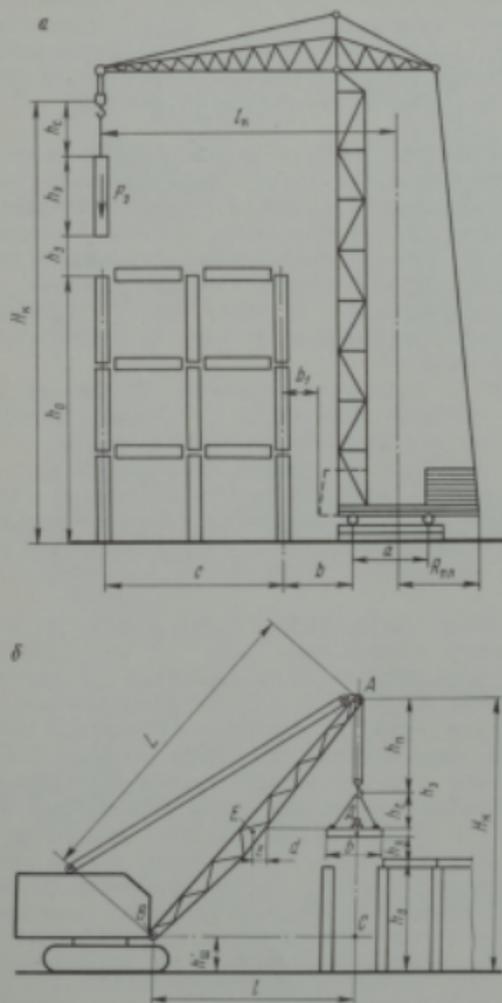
Схема расчета параметров монтажных кранов: а — башенных кранов; б — стреловых кранов
